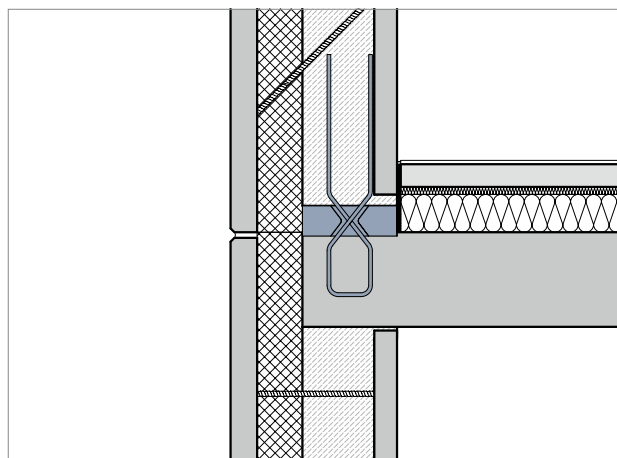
Schématické znázornění prvku Schöck Sconnex® typ W u poloprefabrikovaných stěn a podstropní tepelné izolace
